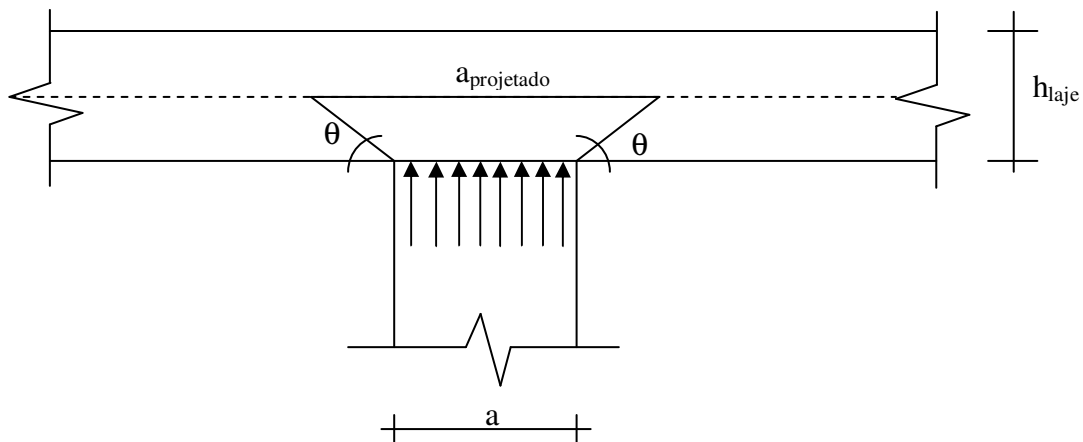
Seção do pilar projetada no centro geométrico da laje
